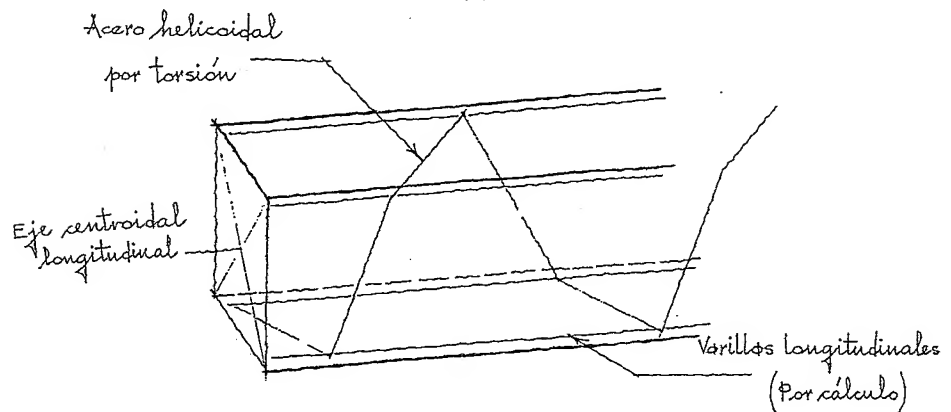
Refuerzo helicoidal. Corte longitudinal.
